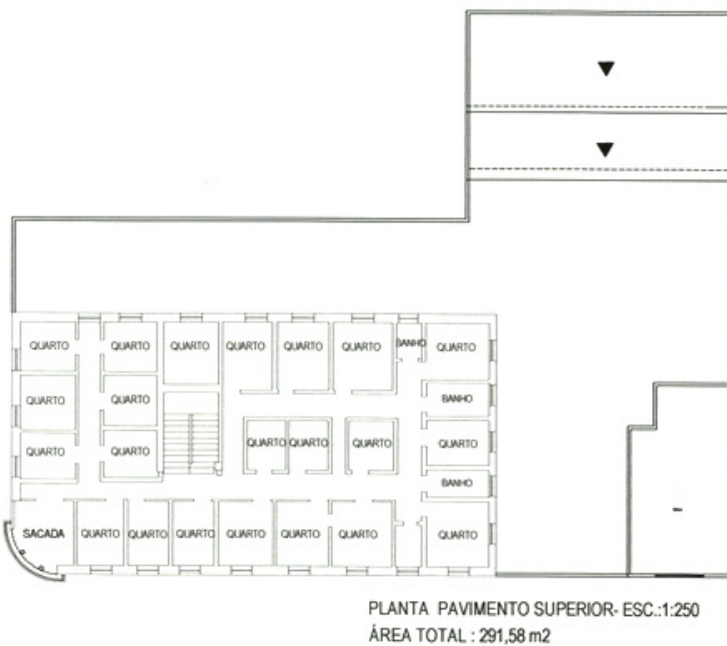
Planta do Pavimento Superior do Palace Hotel de Campinas.
